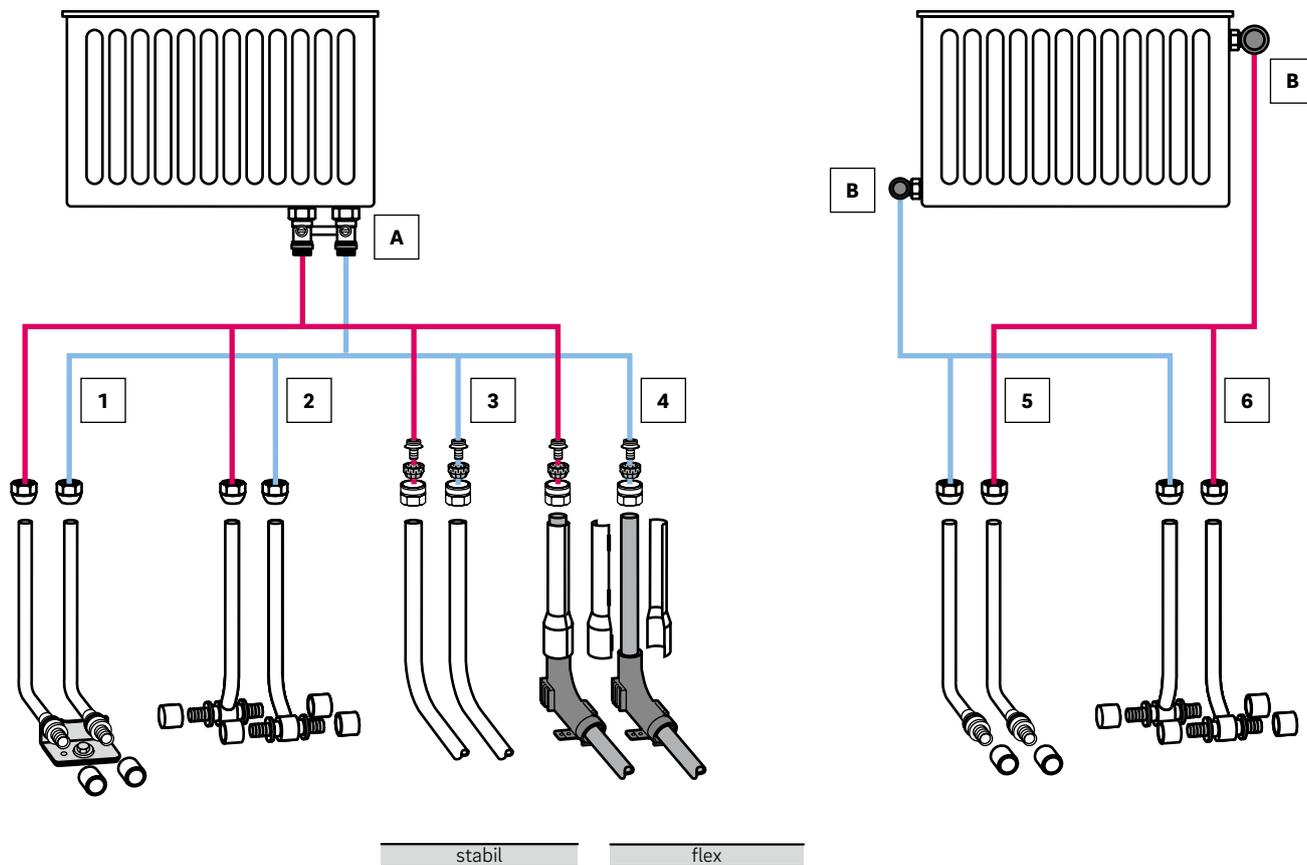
Vue d'ensemble des raccords au radiateur depuis le sol
